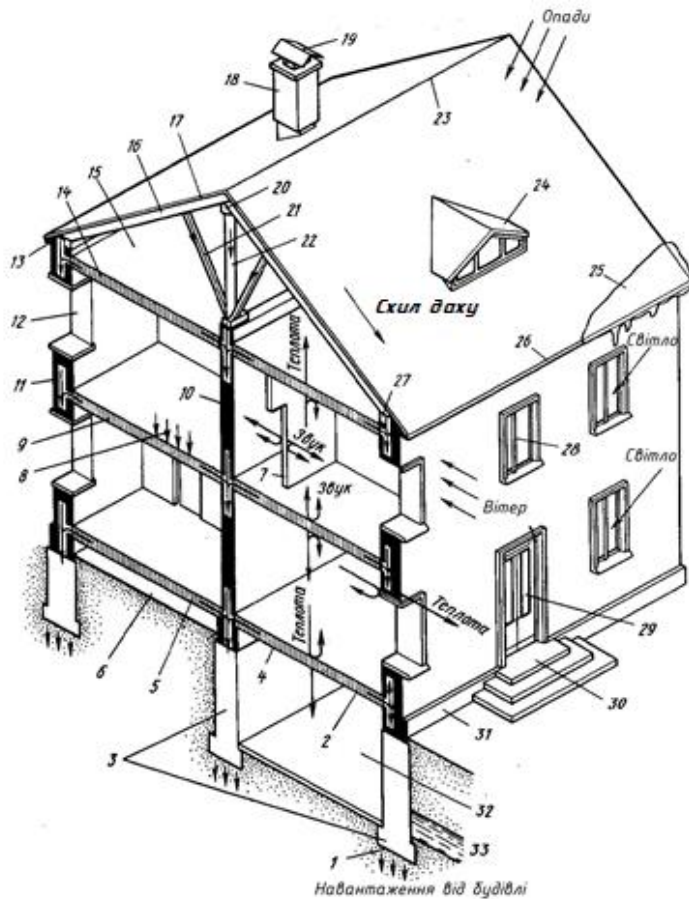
Основні конструктивні елементи будівлі з несучими стінами (наочне зображення): 1 – підшва фундаменту, 2 – надпідвальне перекриття, 3 – фундаменти, 4 - стеля, 5 – нижнє перекриття, 6 – простір під нижнім перекриттям, 7 – перегородка, 8 – навантаження від власної ваги будівлі, людей та устаткування, 9 – міжповерхове перекриття, 10 – поздовжня внутрішня стіна, 11 – зовнішня стіна, 12 – віконний проріз, 13 – карниз, 14 – горищене перекриття, 15 – горище, 16 – кроква, 17 – покрівля, 18 – комин, 19 – зонт, 20 – гребневий прогін, 21 – підкіс, 22 – стійка, 23 – гребінь, 24 – слухове вікно, 25 – сніг, 26 – карниз, 27 – мауерлат, 28 – вікно, 29 – вхідні двері, 30 – ганок, 31 – цоколь, 32 – підвал, 33 – ґрунтова волога.
